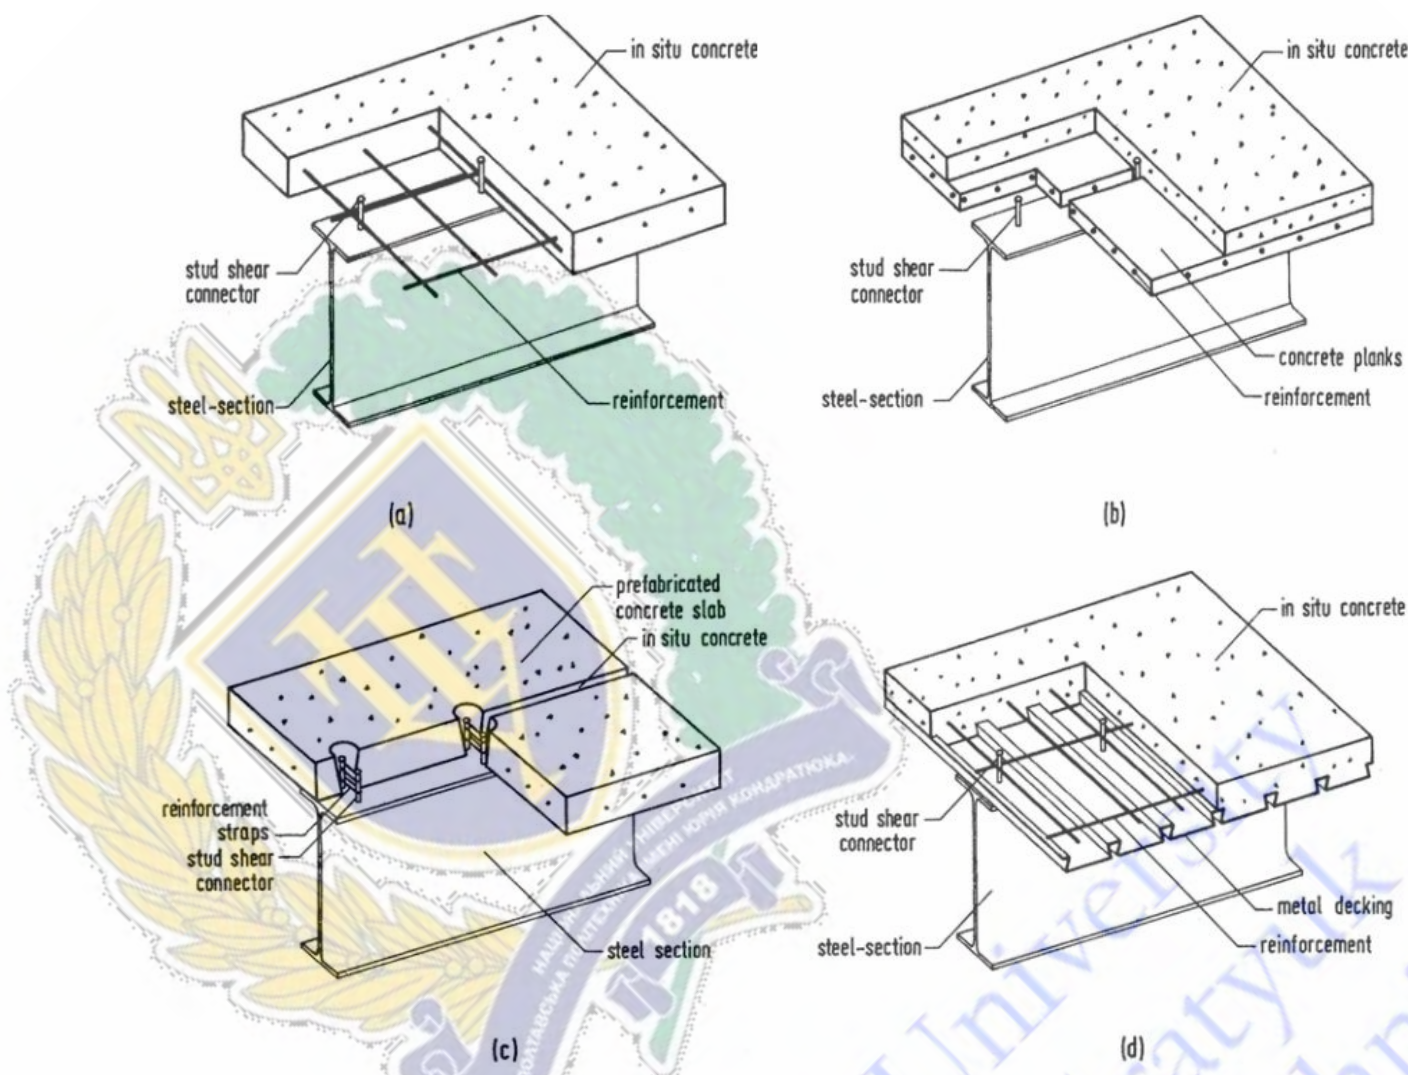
Конструктивні рішення перекриттів будівель із сталезалізобетонних комбінованих балок згідно рекомендацій європейських норм [116], які виготовлені із конструкційного сталюого профілю (steel section) та верхньої залізобетонної чи сталезалізобетонної полиці наступних конструктивних вирішень: а) монолітної залізобетонної плити; б) збірно-монолітної залізобетонної плити; с) збірної залізобетонної плити і монолітних монтажних вузлів; д) сталезалізобетонної монолітної плити з нез'ємною опалубкою із профільованого сталюого листа.
